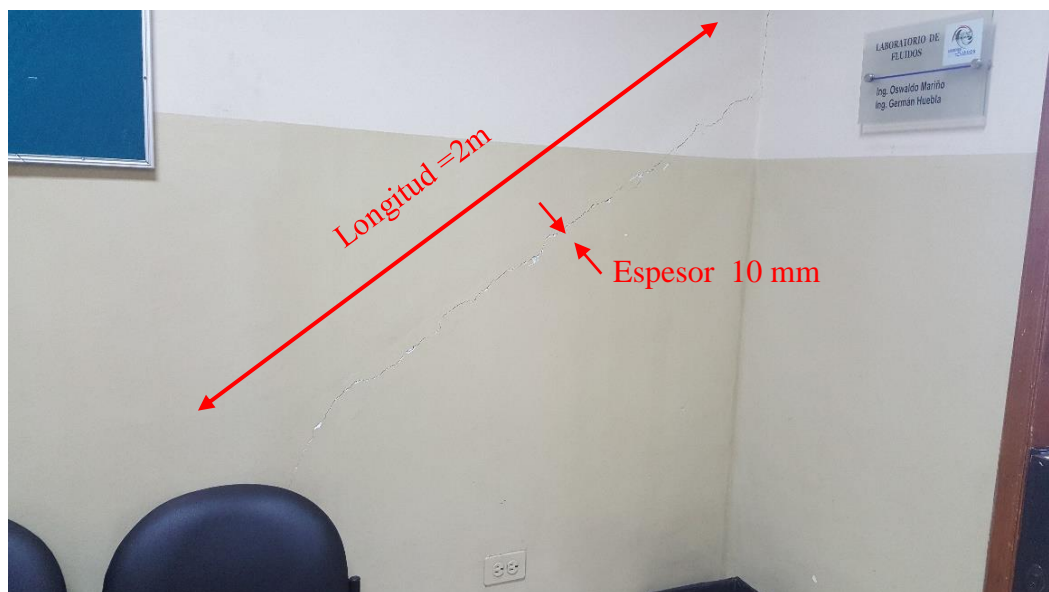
Grieta en mampostería, Planta alta eje D entre 1 y 2
